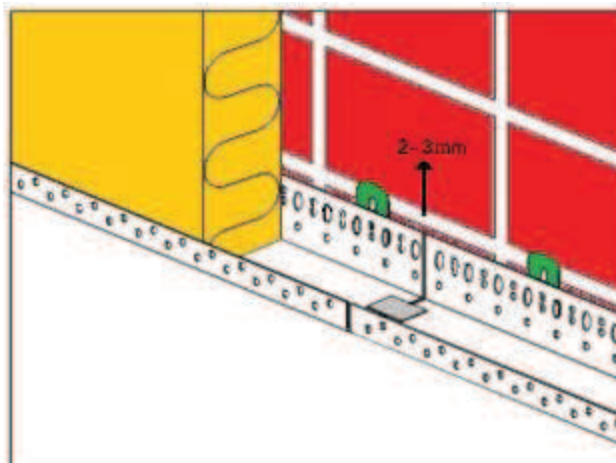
Založení základací lišty (varianta bez zateplení soklu)
